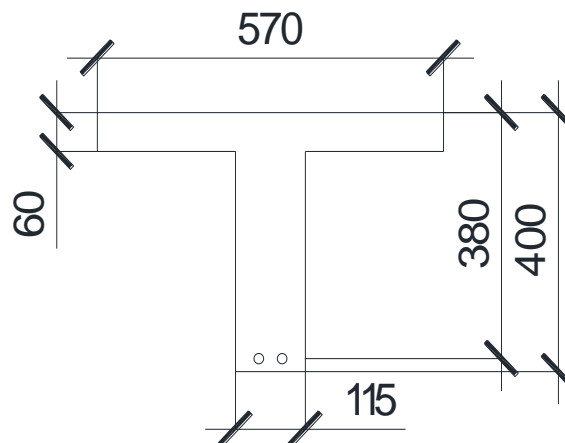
Заданий розрахунковий поперечний переріз фронтального перерізу
